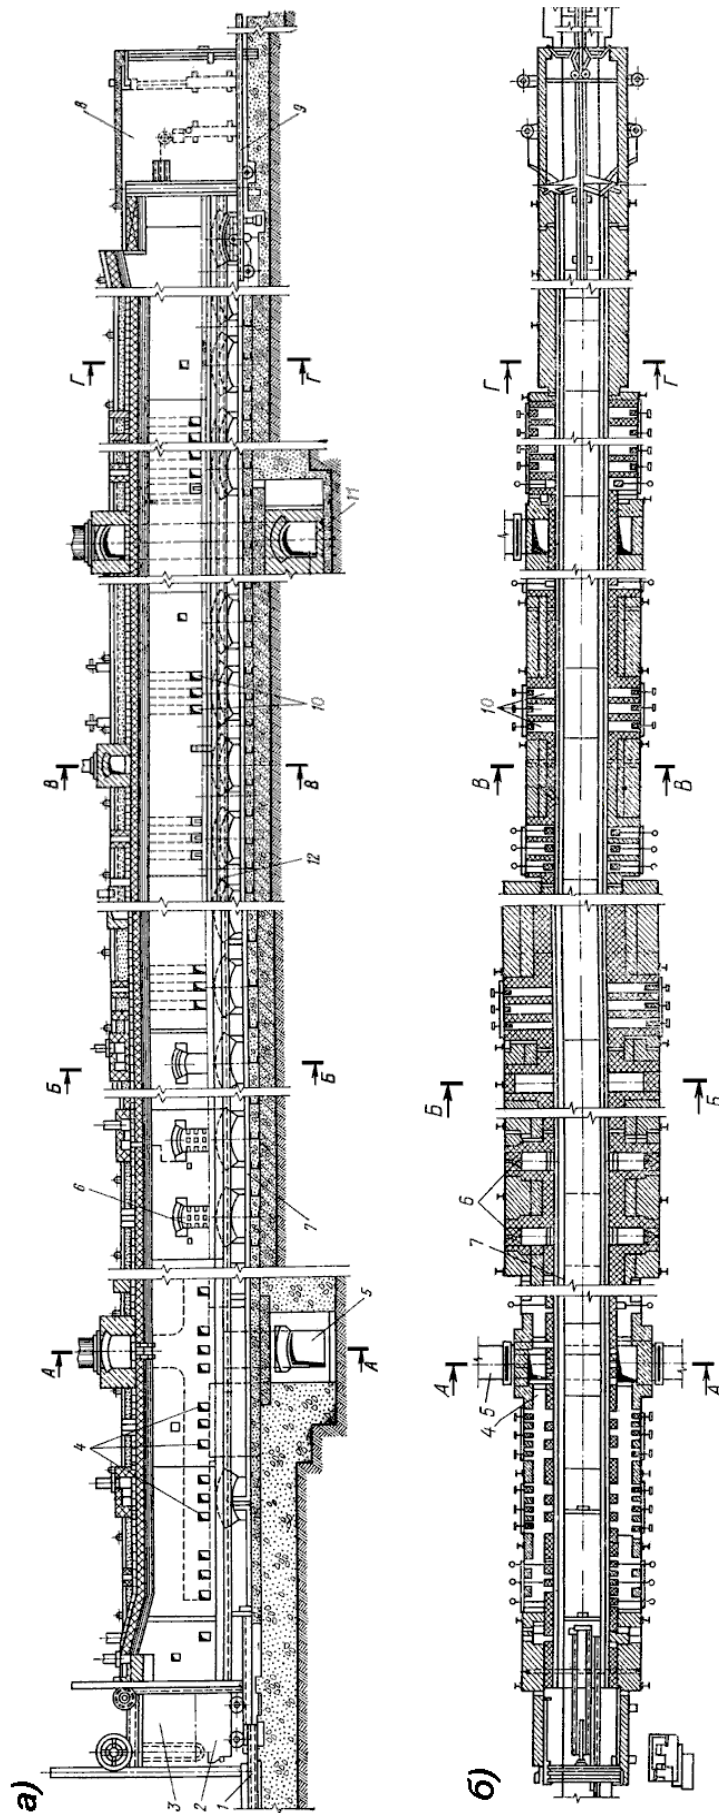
Туннельная печь: А – продольный разрез печи; Б – план
